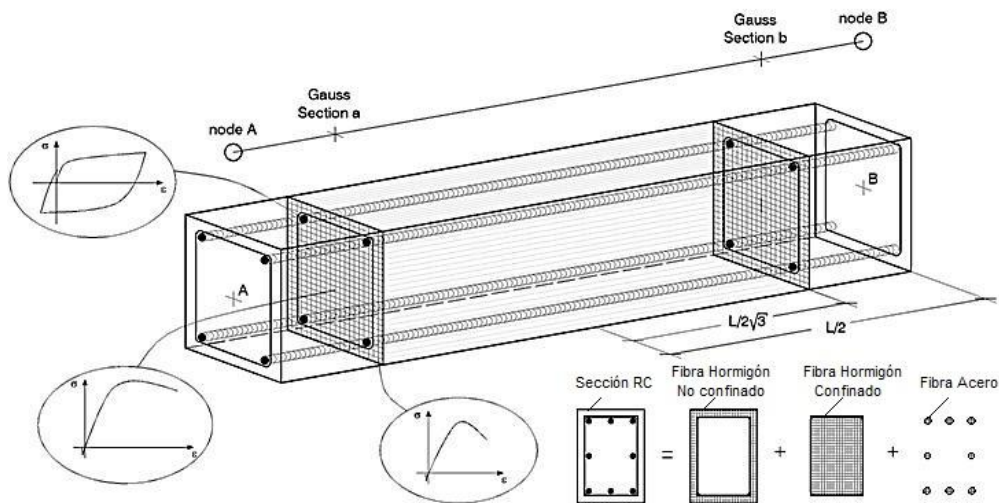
Discretización de una sección típica del modelo de fibras de hormigón armado (adaptado de Seismosoft 2004)
